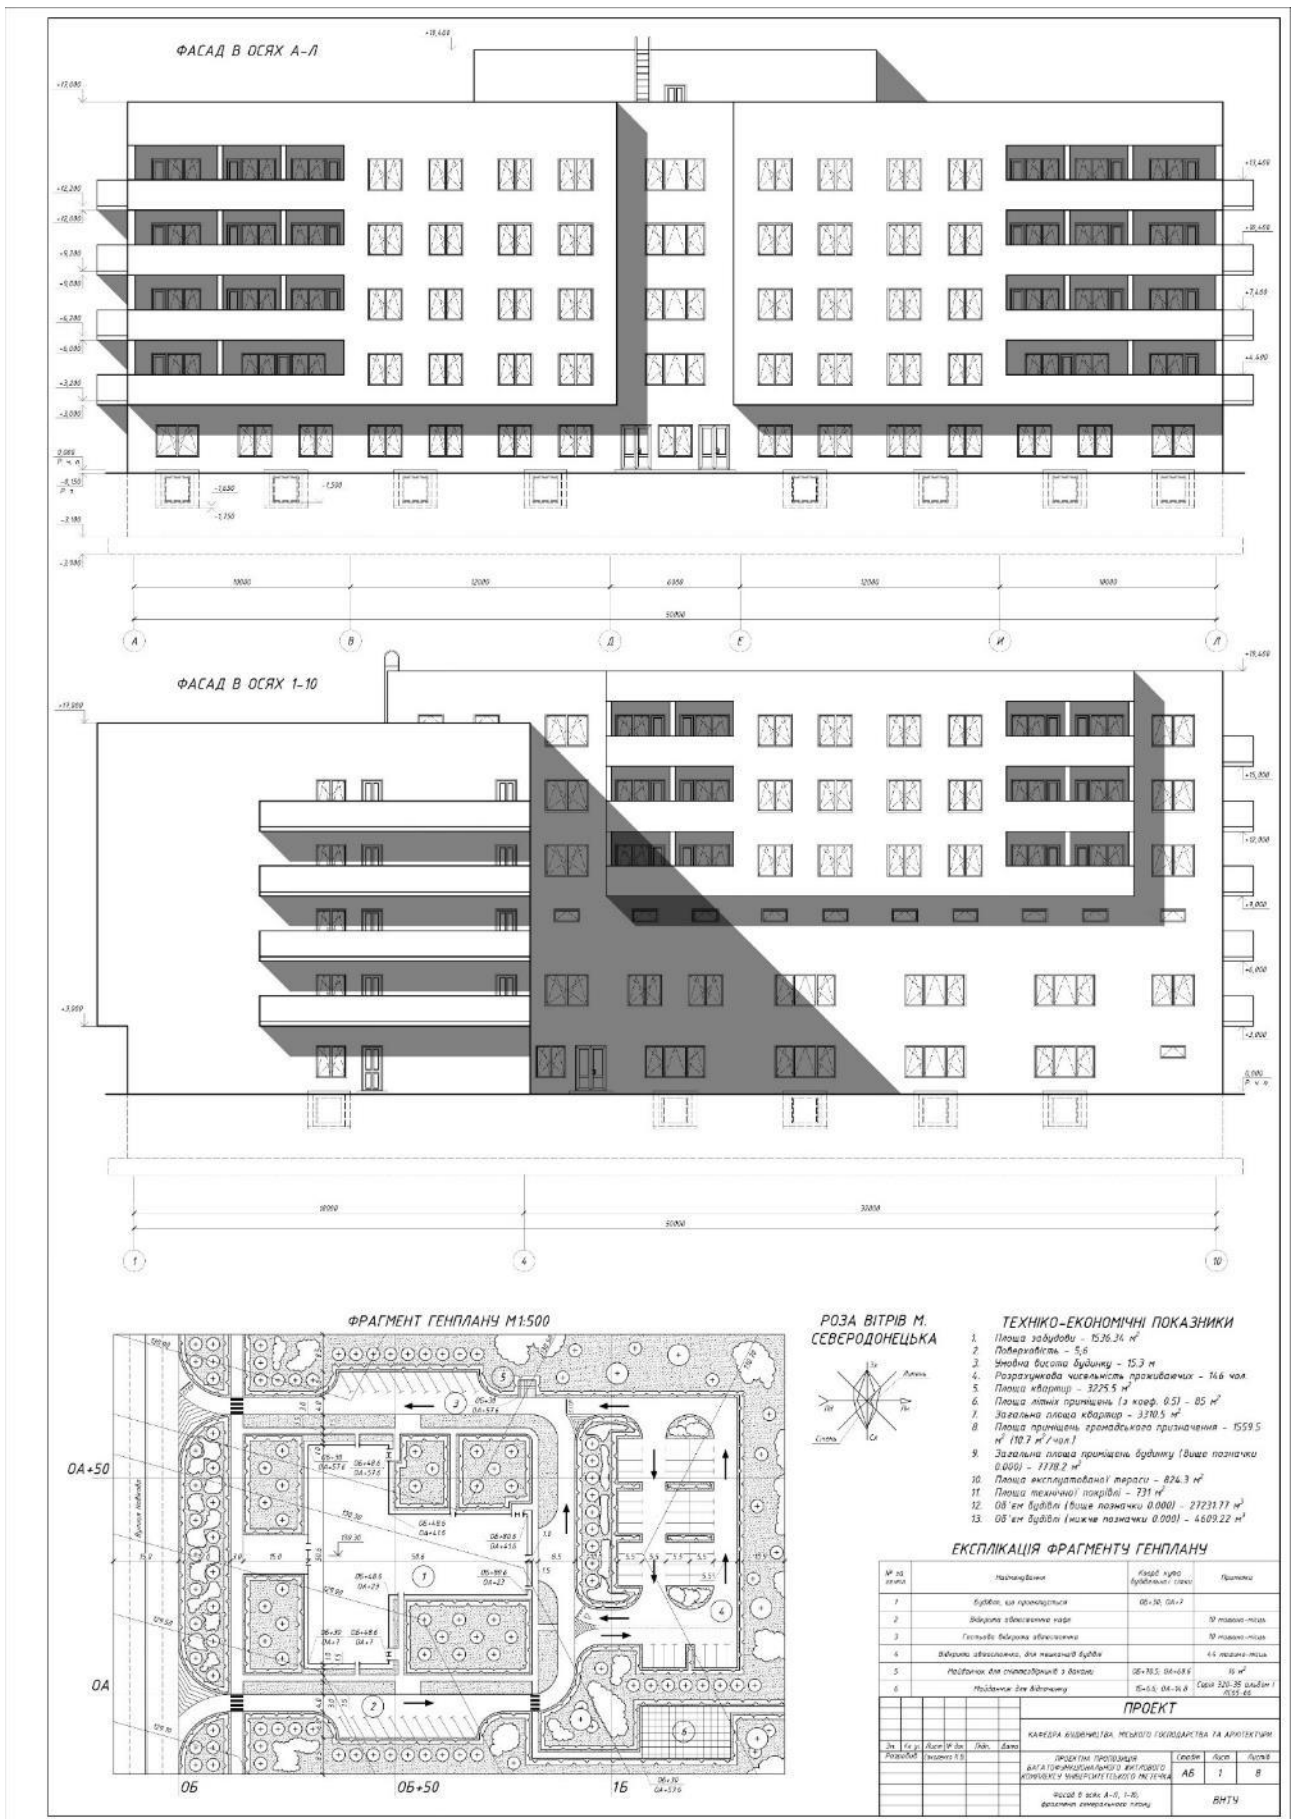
Фасади в осях А-Л та 10-1, фрагмент генерального плану
